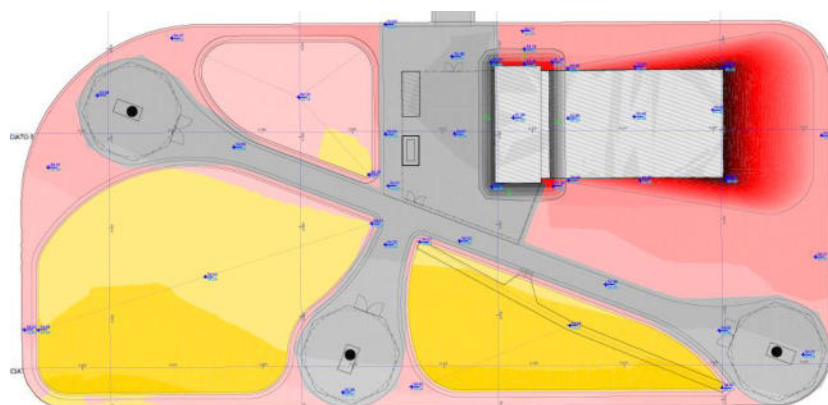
Planimetria fase 2 movimenti terra con indicazione in giallo delle aree soggette a scavo per realizzazione depressioni terreno, e in rosso i rinterri e rilevati.
